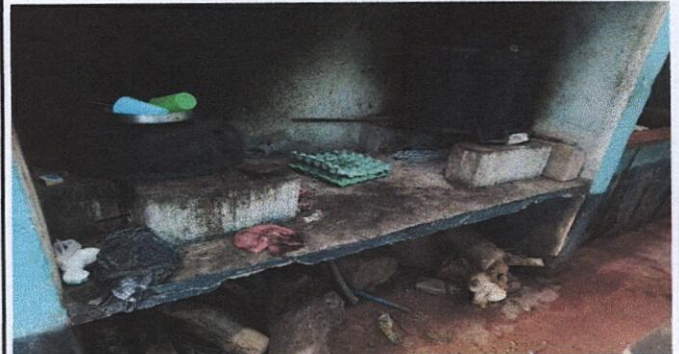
20.2 Sustrucción de estufa rural (completa) incluye chimenea y plancha de metal
